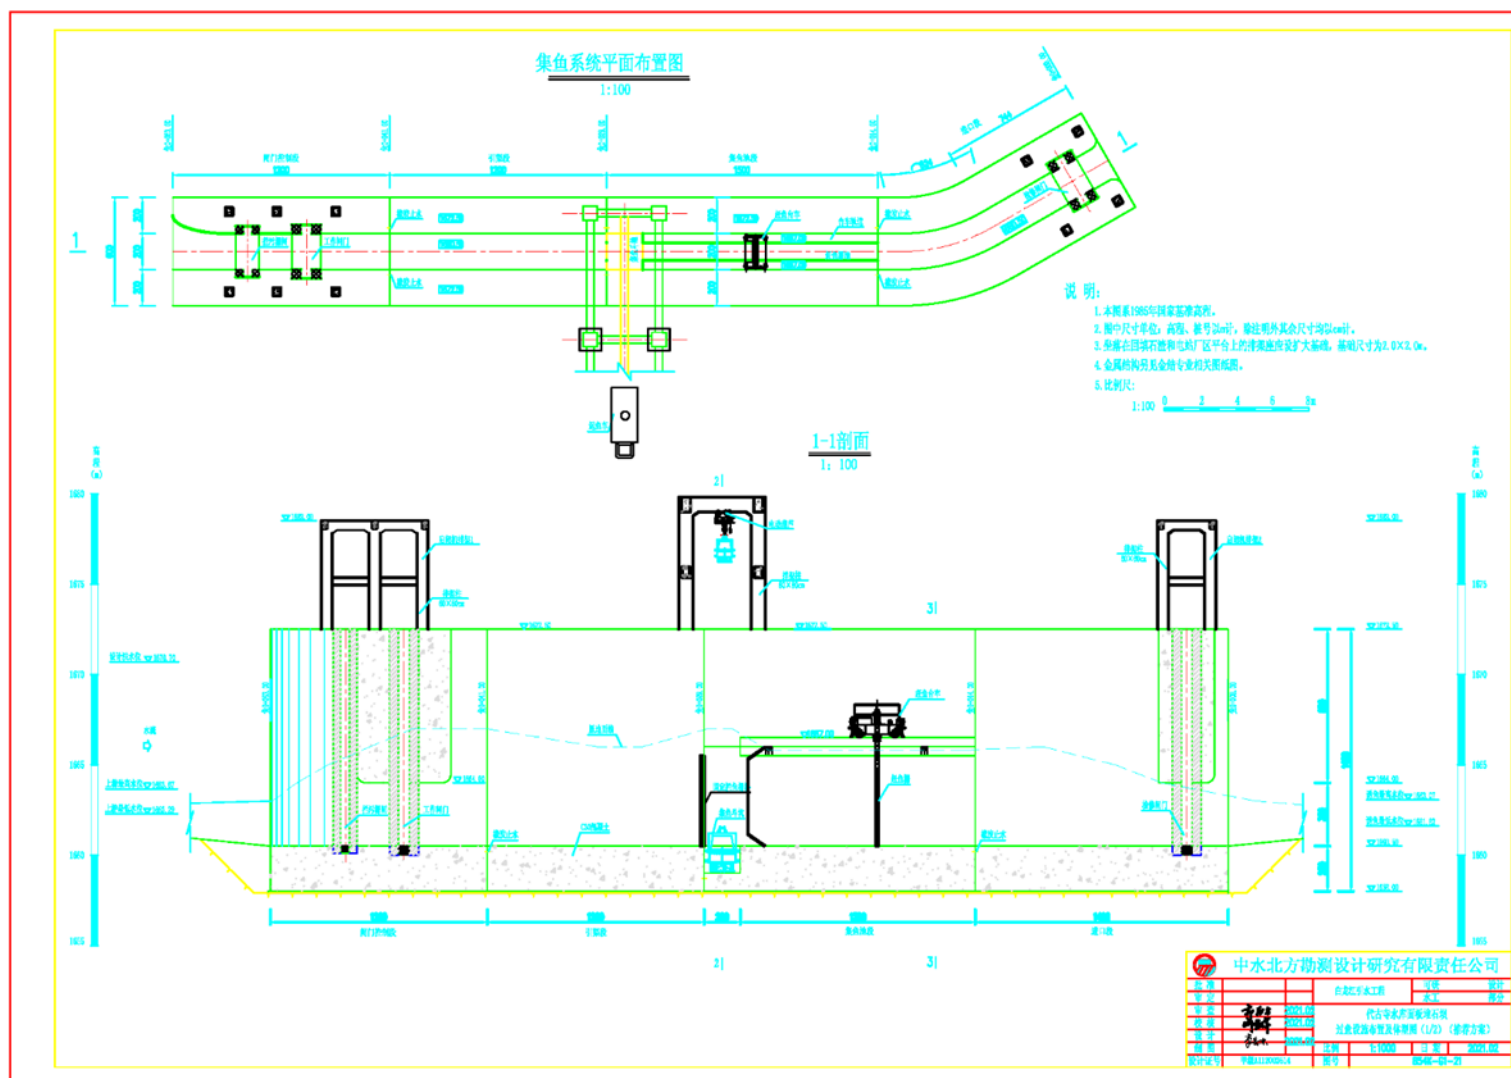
集鱼系统平面布置及剖面图 (一)
